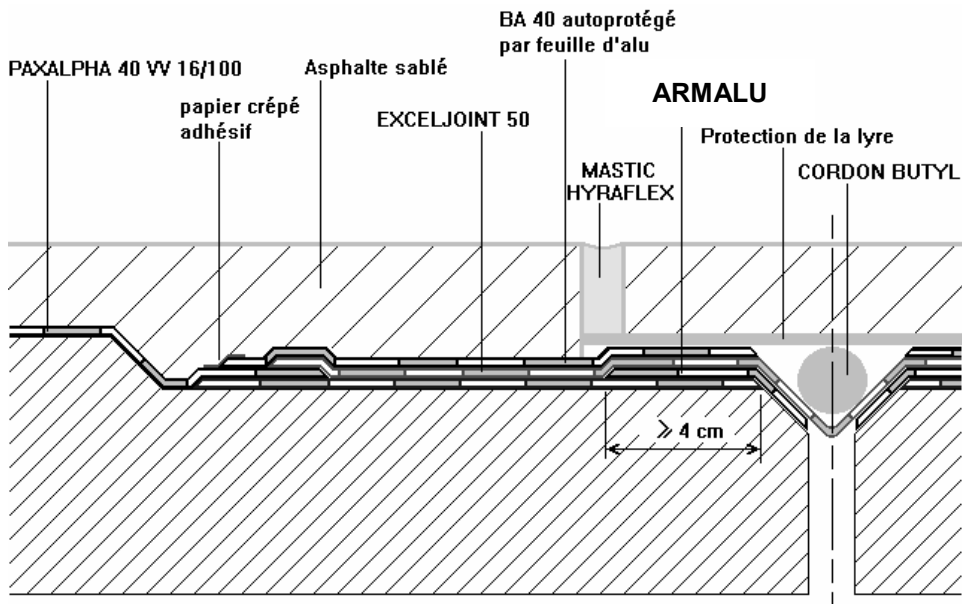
Joint plat raccordé à une étanchéité mixte (feuille + asphalte)
